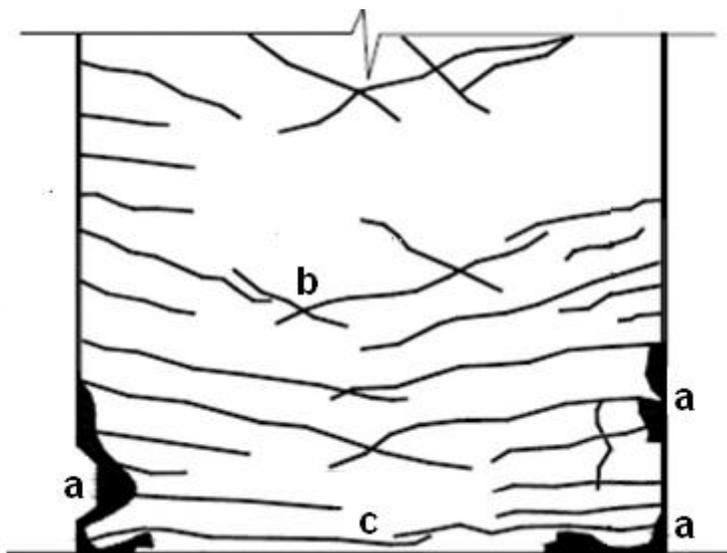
Daños en pared de concreto reforzado: a: Aplastamiento del concreto, b: Fisuras por cortante, c: Fisuras por flexión. (Modificado de Hurtado, 2014)
